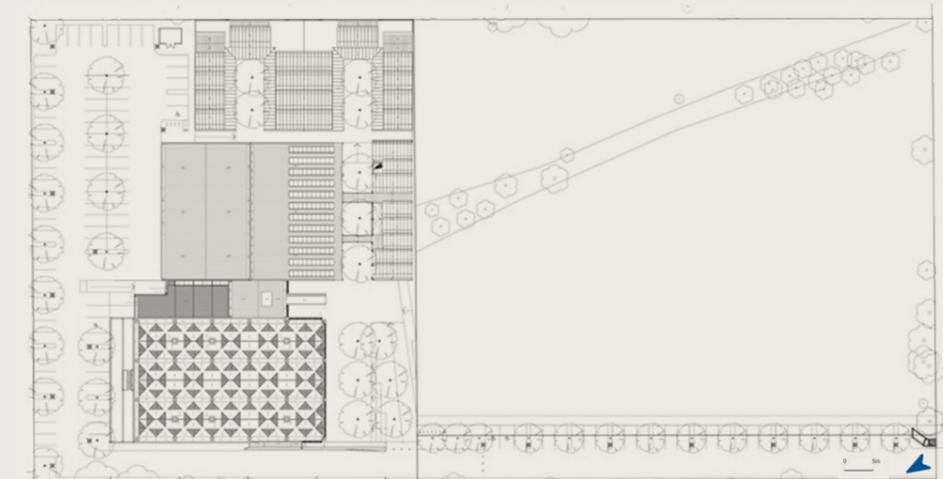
Implantação do projeto. Fonte: ArchDaily.
